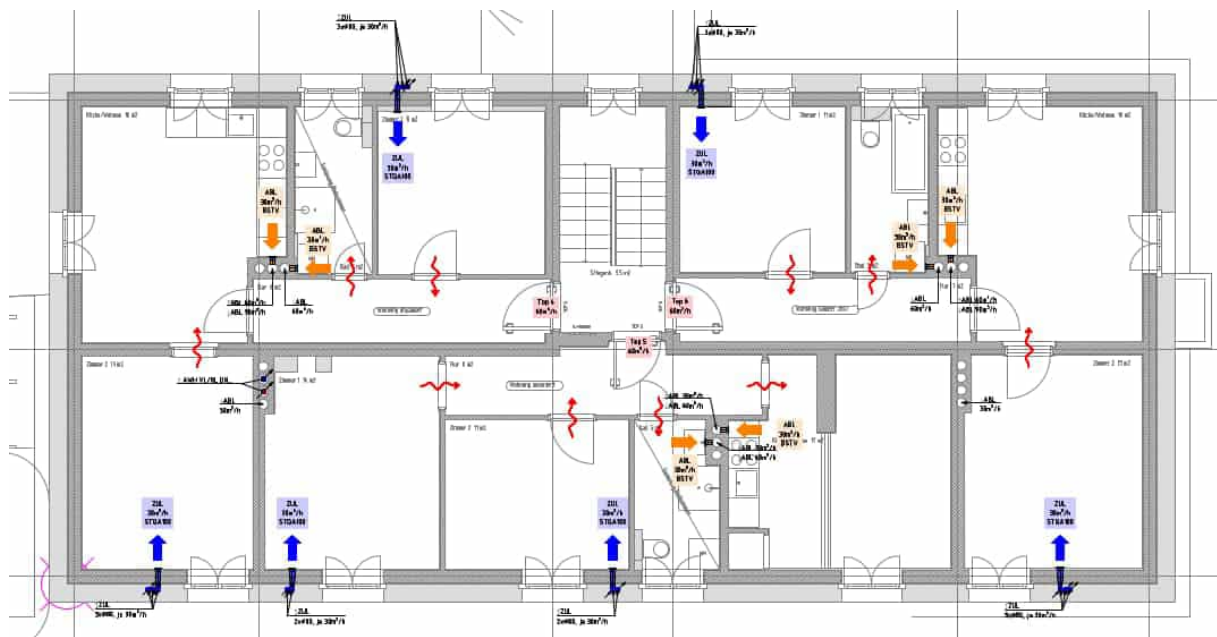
Ausführungsplan Lüftung, EG ; Planungsteam E-Plus
